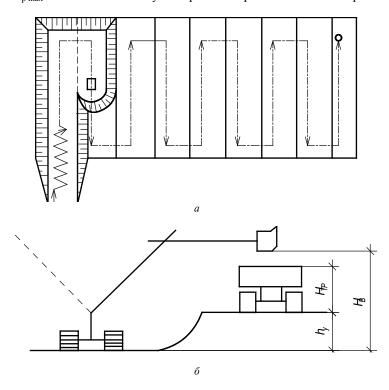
Разработка прямыми лопатами выемок с большими размерами поперечных сечений: a – план выемки с разбивкой на ленты разработки; δ – схема разработки грунта в пионерных лентах с заглублением транспортных путей
